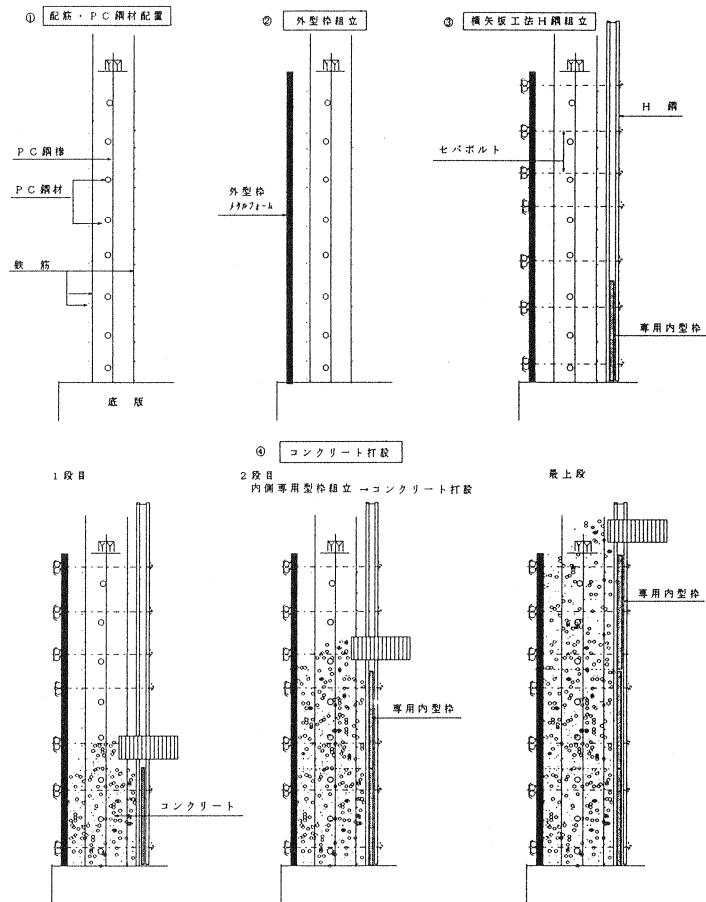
PCタンク側壁コンクリートを一度に打設する施工方法
